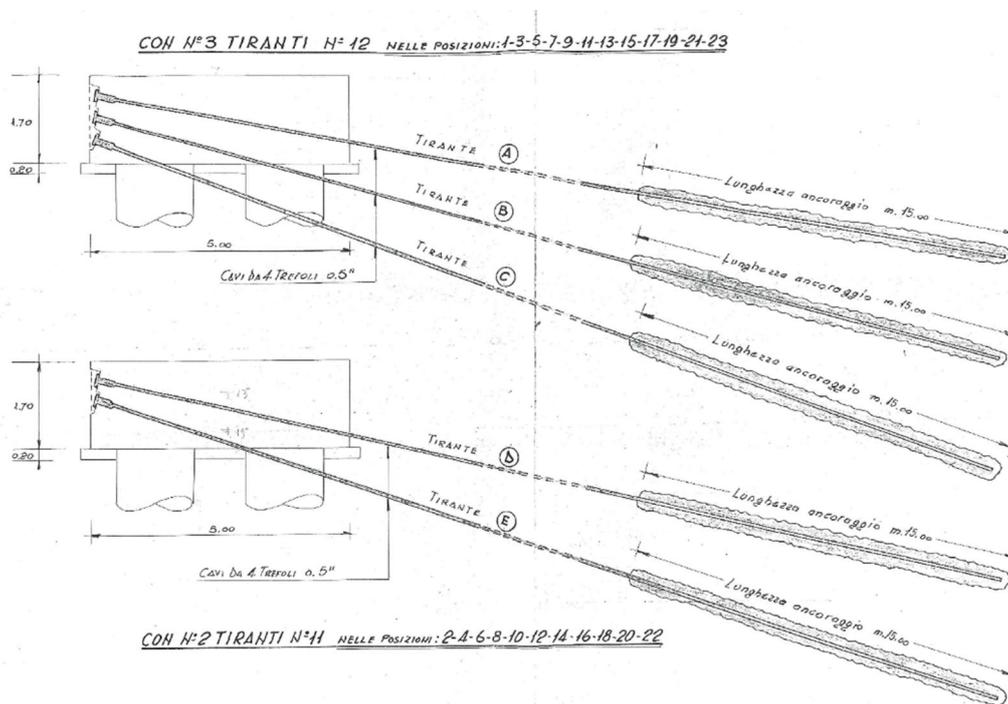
Viadotto Cacchione – Paratia di pali a protezione delle Spalle lato Bari - Sezione (Doc.Ref.[7] e [18])
